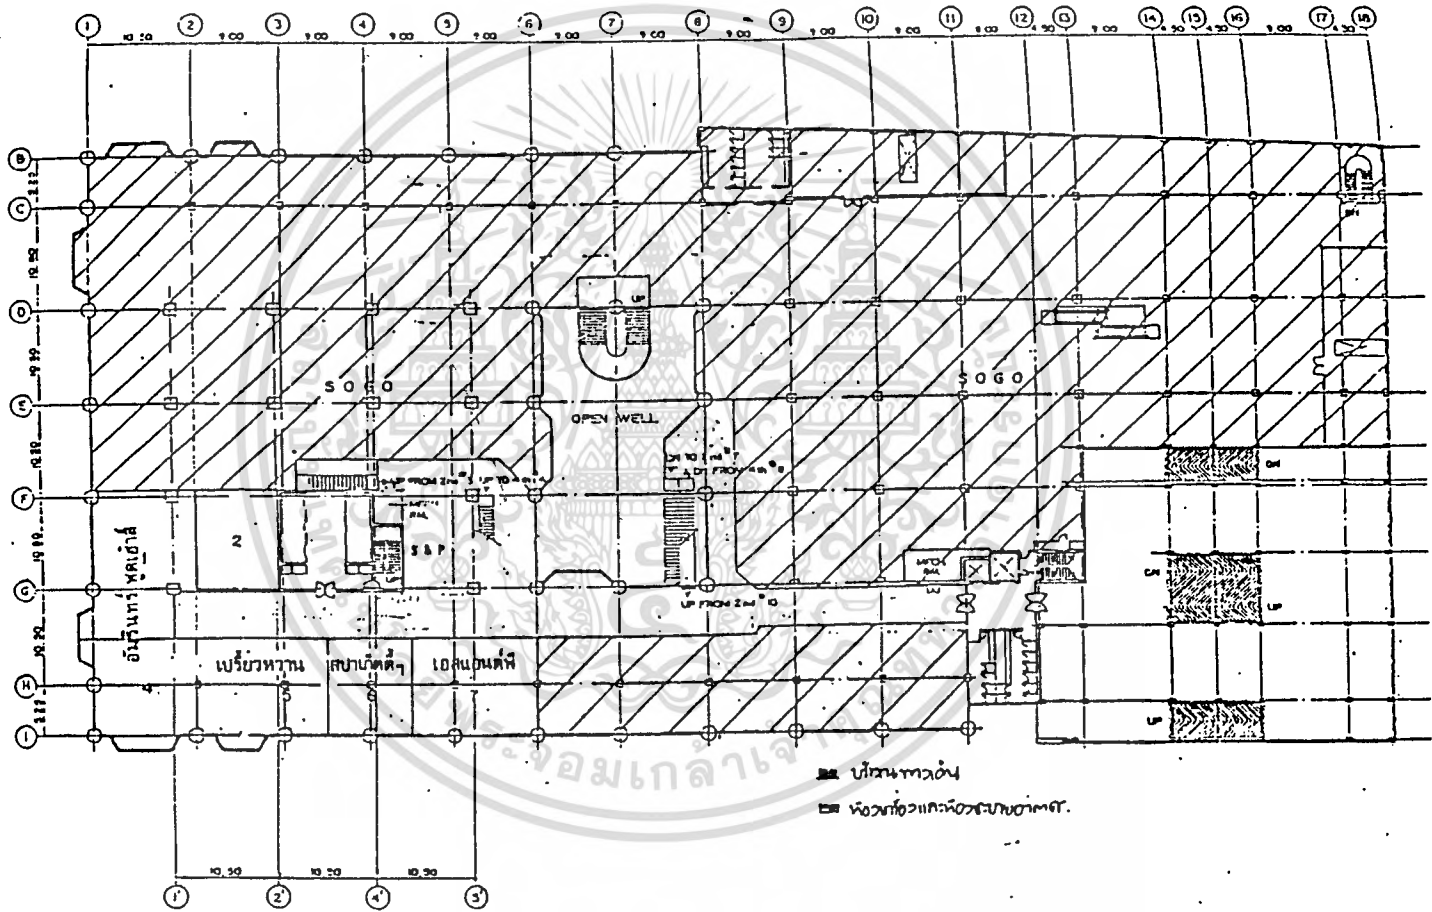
ชั้น 1 GROUND FLOOR PLAN
